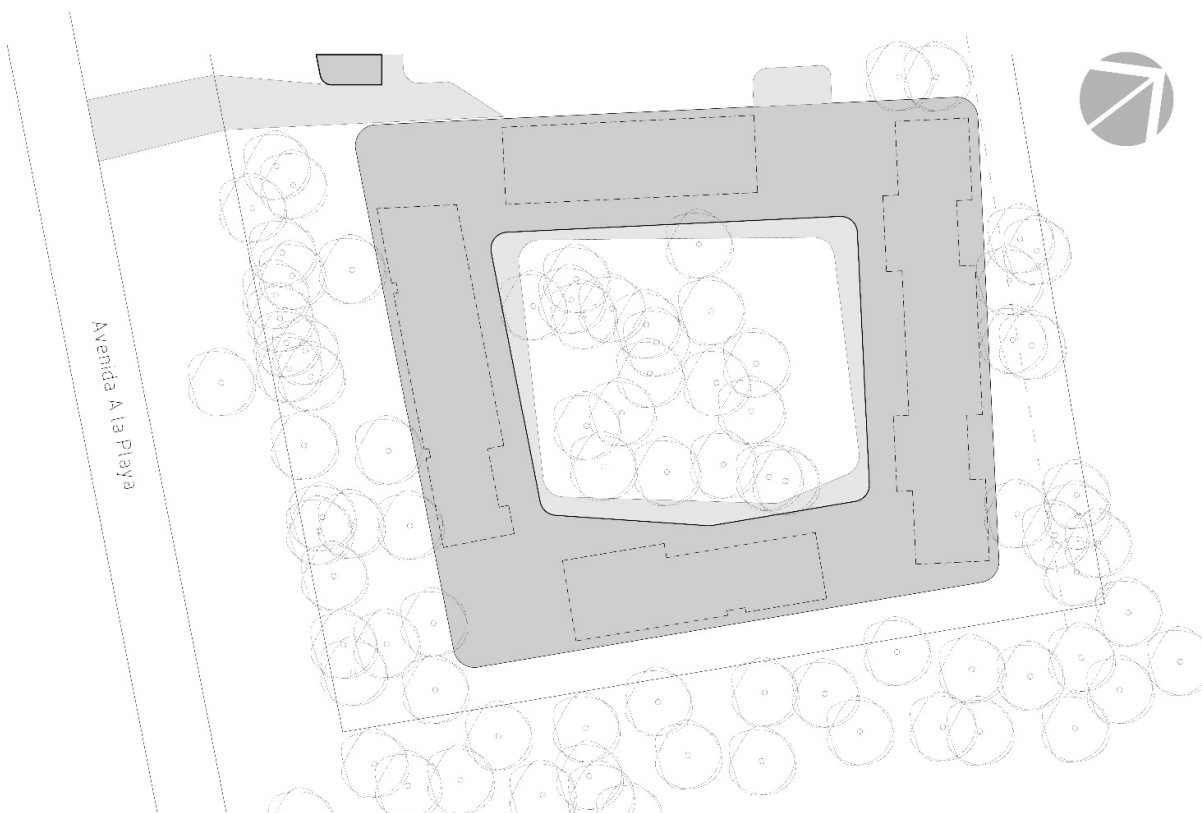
, esquema de planta de las construcciones sobre el terreno, se indica en gris el área cubierta, en gris claro el pavimento exterior rígido y con línea punteada las construcciones cerradas bajo la cubierta. Se observan los árboles existentes a conservar.
